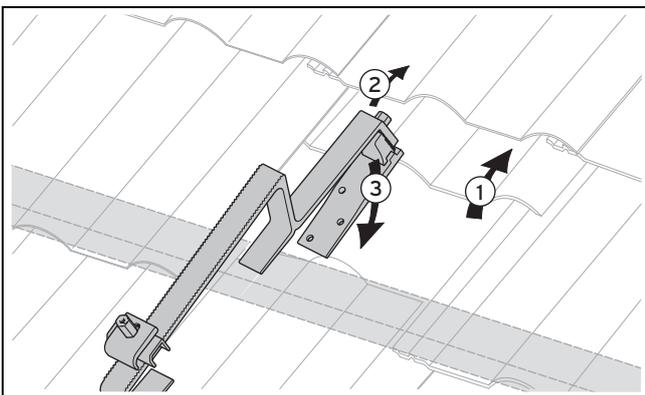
Dachlatte freilegen und Dachanker Typ P anlegen
